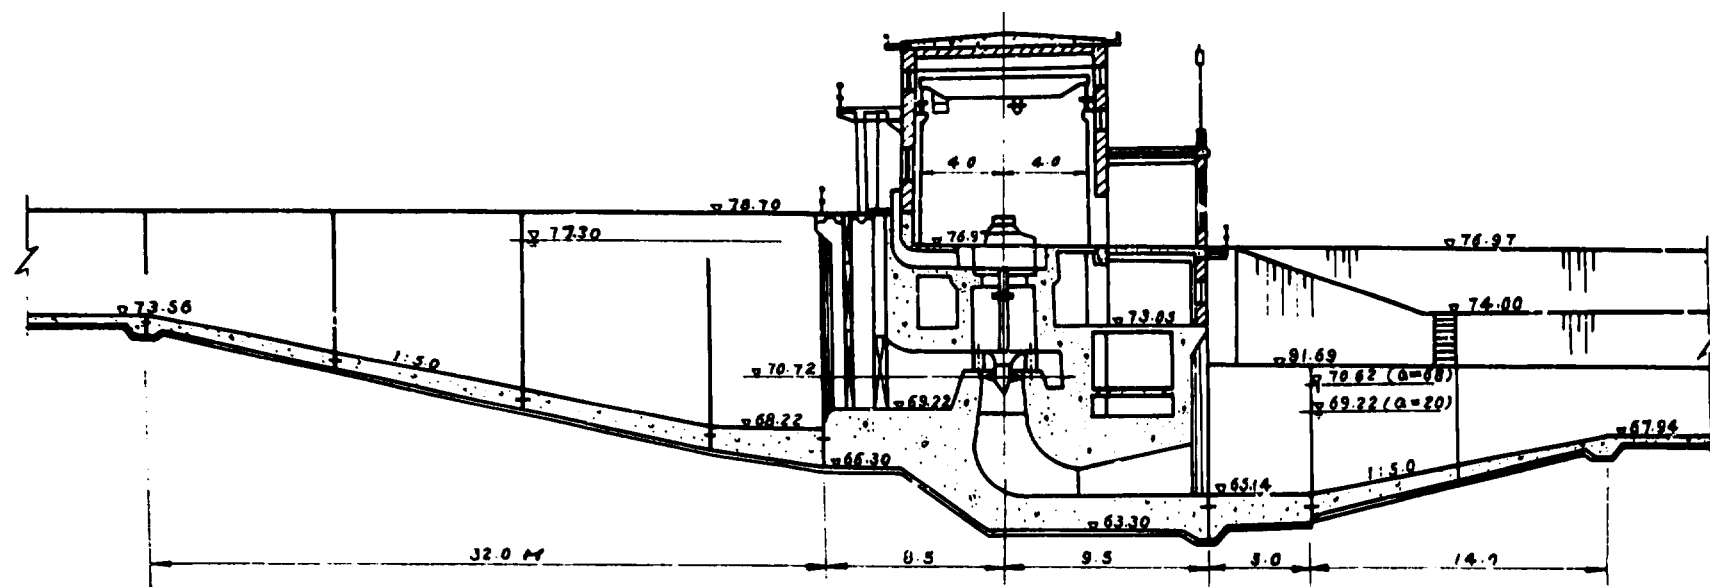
Plan de la Central hidroeléctrica No. 3 sobre el canal Beijing - MIMYUN
